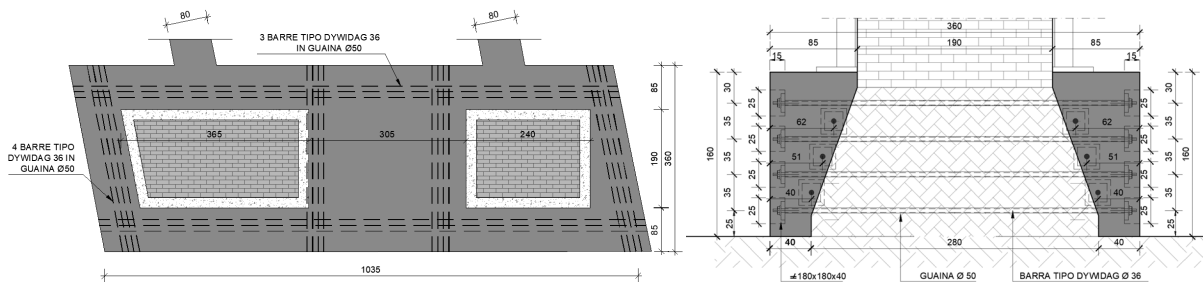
Adeguamento della Soluzione PD di riferimento: consolidamento strutturale delle fondazioni del ponte in muratura – Pianta e Sezione
